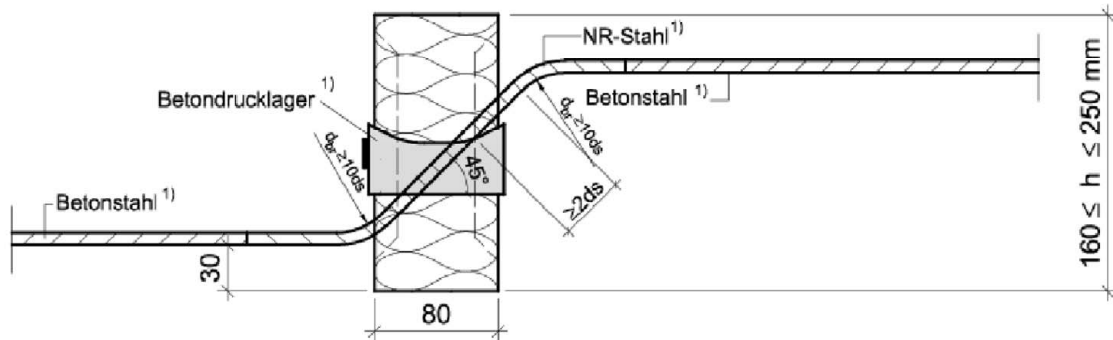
Schöck Isokorb® T Typ Q-ID mit Betondrucklager
